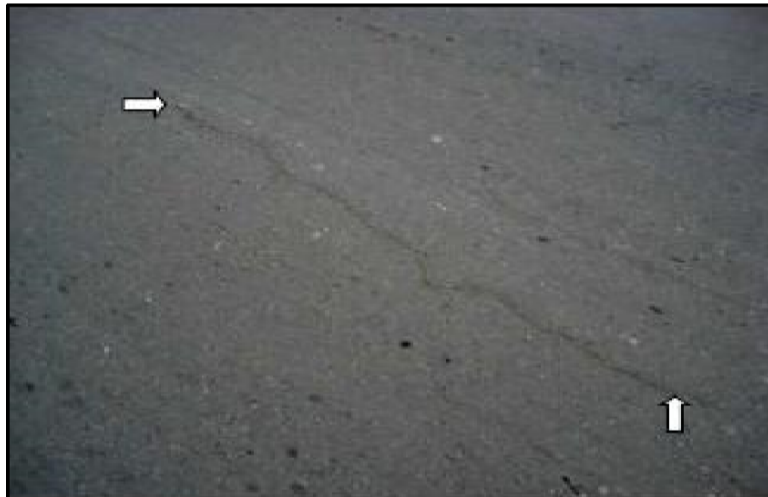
Patología por grietas longitudinales y transversales.
